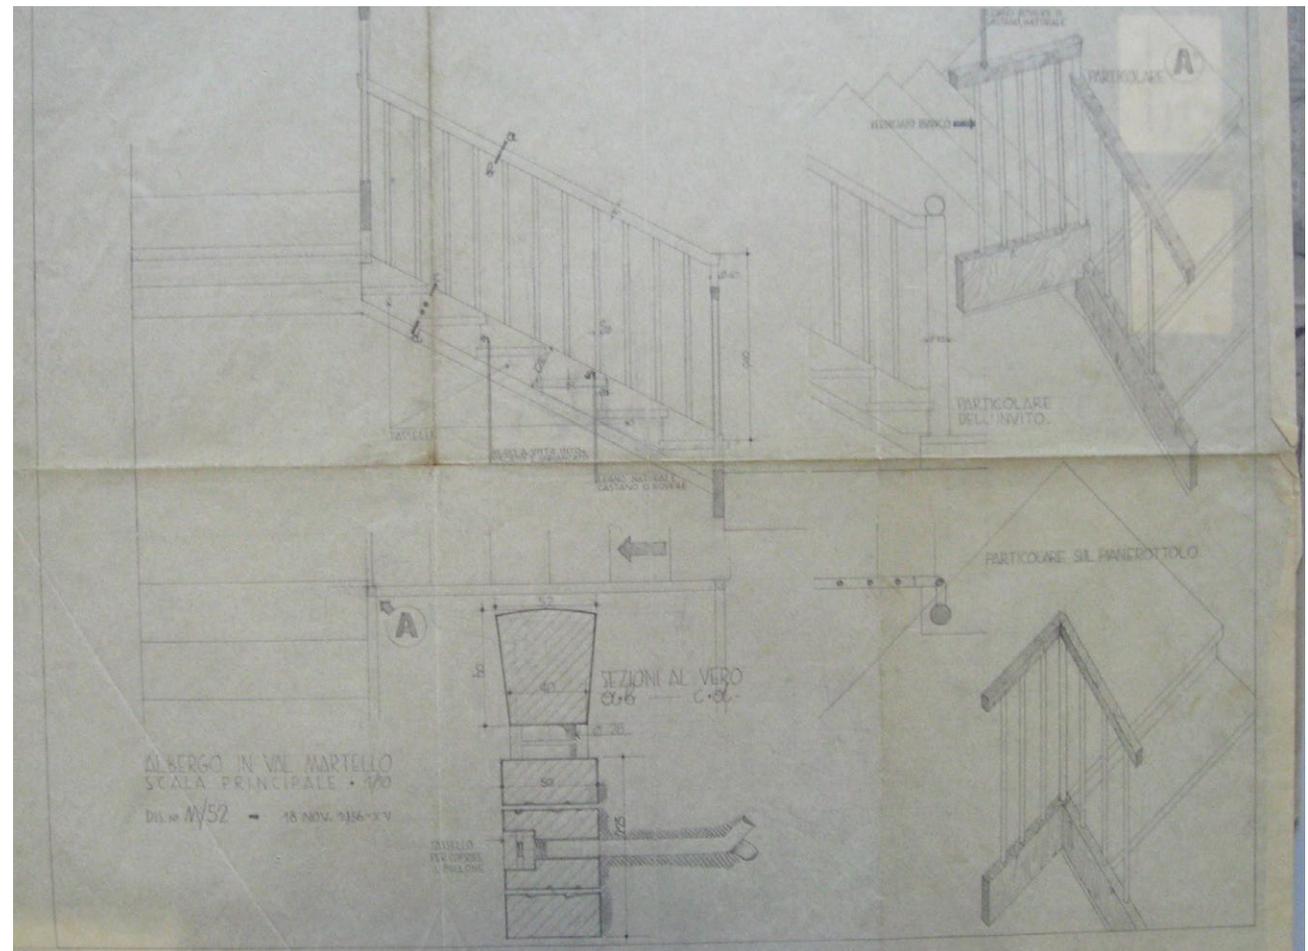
Gio Ponti, detaillierter Plan der Treppe
